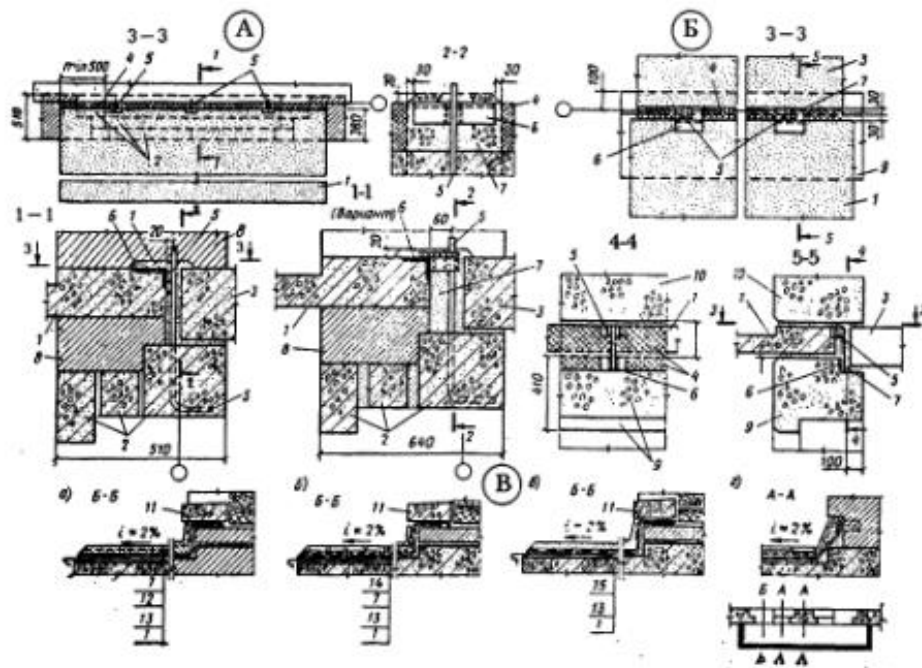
Конструкции балконов: А,Б - опирание и крепление балконной плиты в кирпичной (А) и крупноблочной (Б) стенах; В - примеры конструкции полов балкона (лоджки); а - цементного; б - из керамических плиток; в - асфальтобетонного; г - примыкание пола к стене; 1 - балконная плита; 2 - железобетонные оконные перемычки; 3 - настил перекрытия; 4 - утеплитель; 5 - стальные анкеры; 6 - закладные детали; 7 - цементный раствор; 8 - кирпичная кладка; 9 - стеновой перемычный блок; 10 - то же, простеночный (подоконный); 11 - бетонная ступень балкона; 12 - арматурная сетка; 13 - гидроизоляция (два слоя рубероида); 14 - керамические плитки; 15 - асфальтобетон (30 мм)
